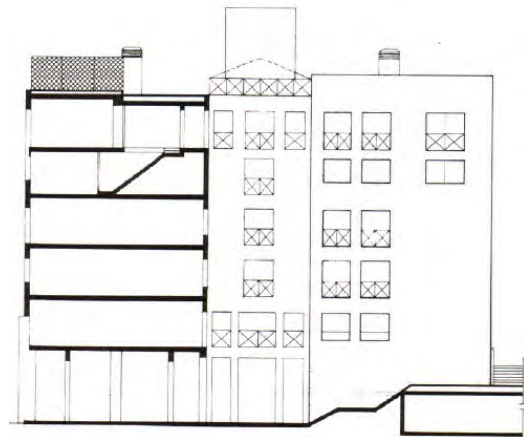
Secció transversal, c/Om - Arc del Teatre, Barcelona. Aparcament sota pati interior sobre elevat.
